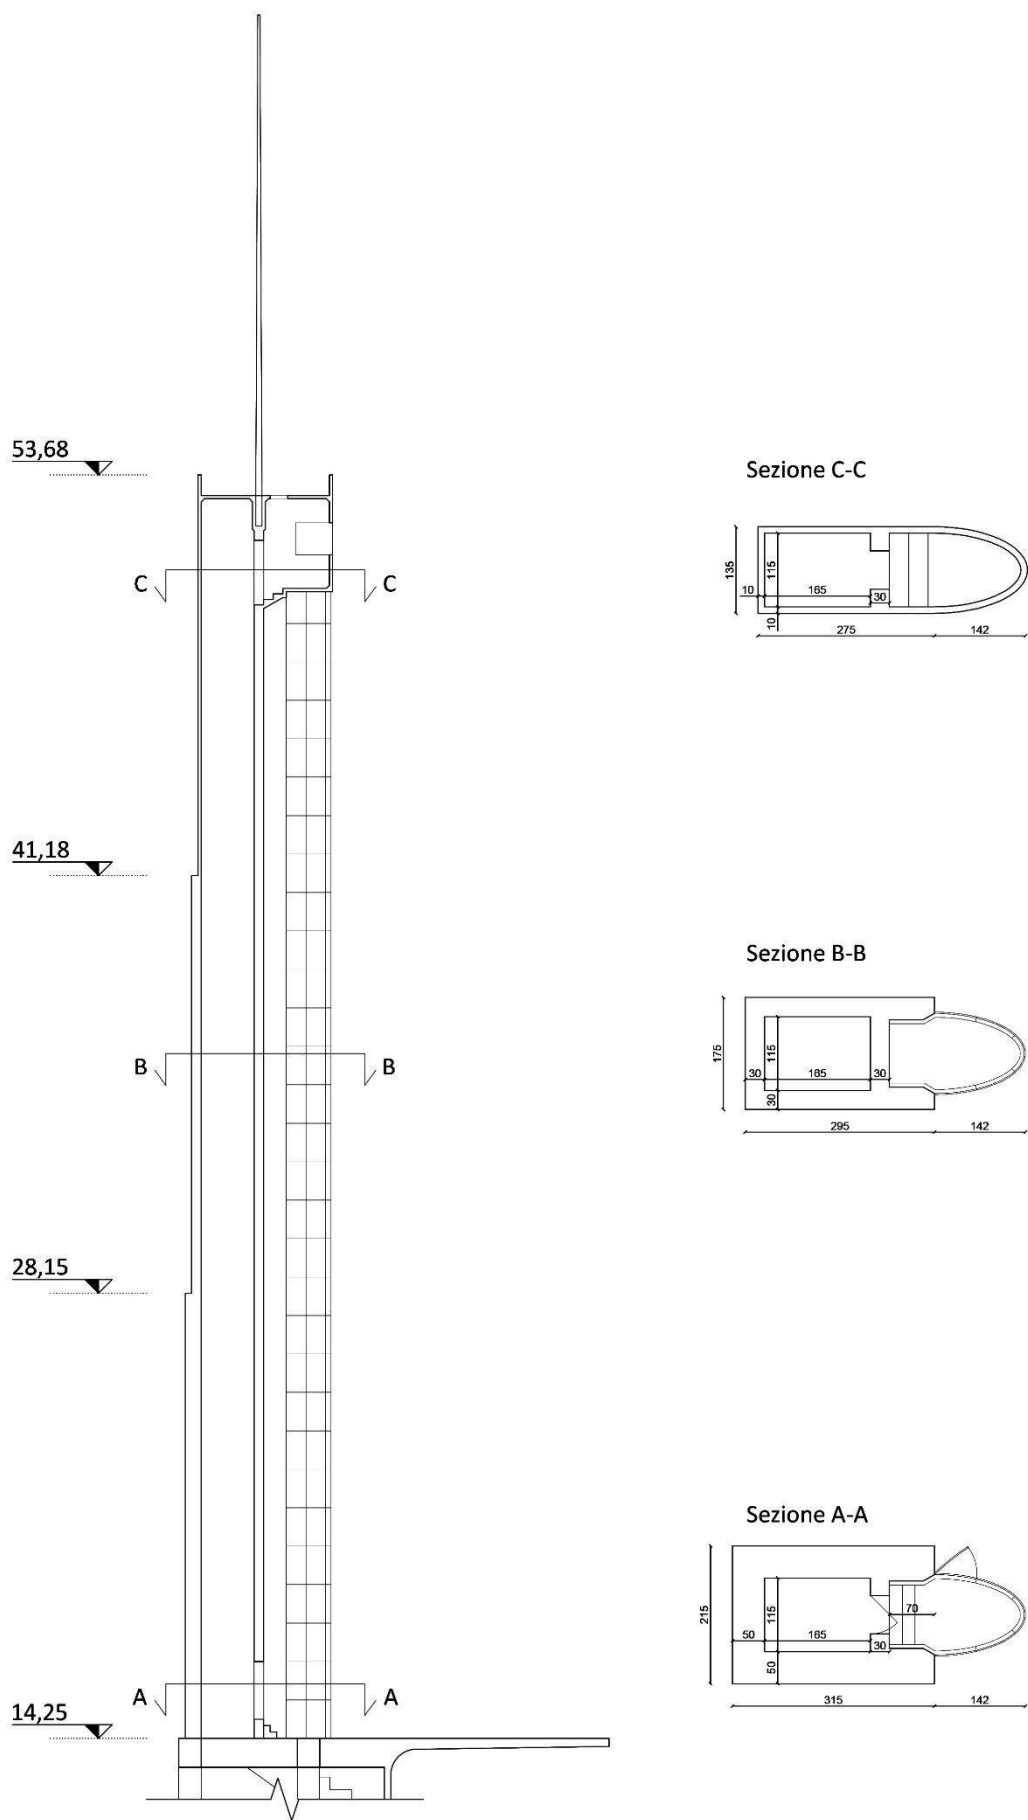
Torre di Maratona: sezione verticale e sezioni trasversali
